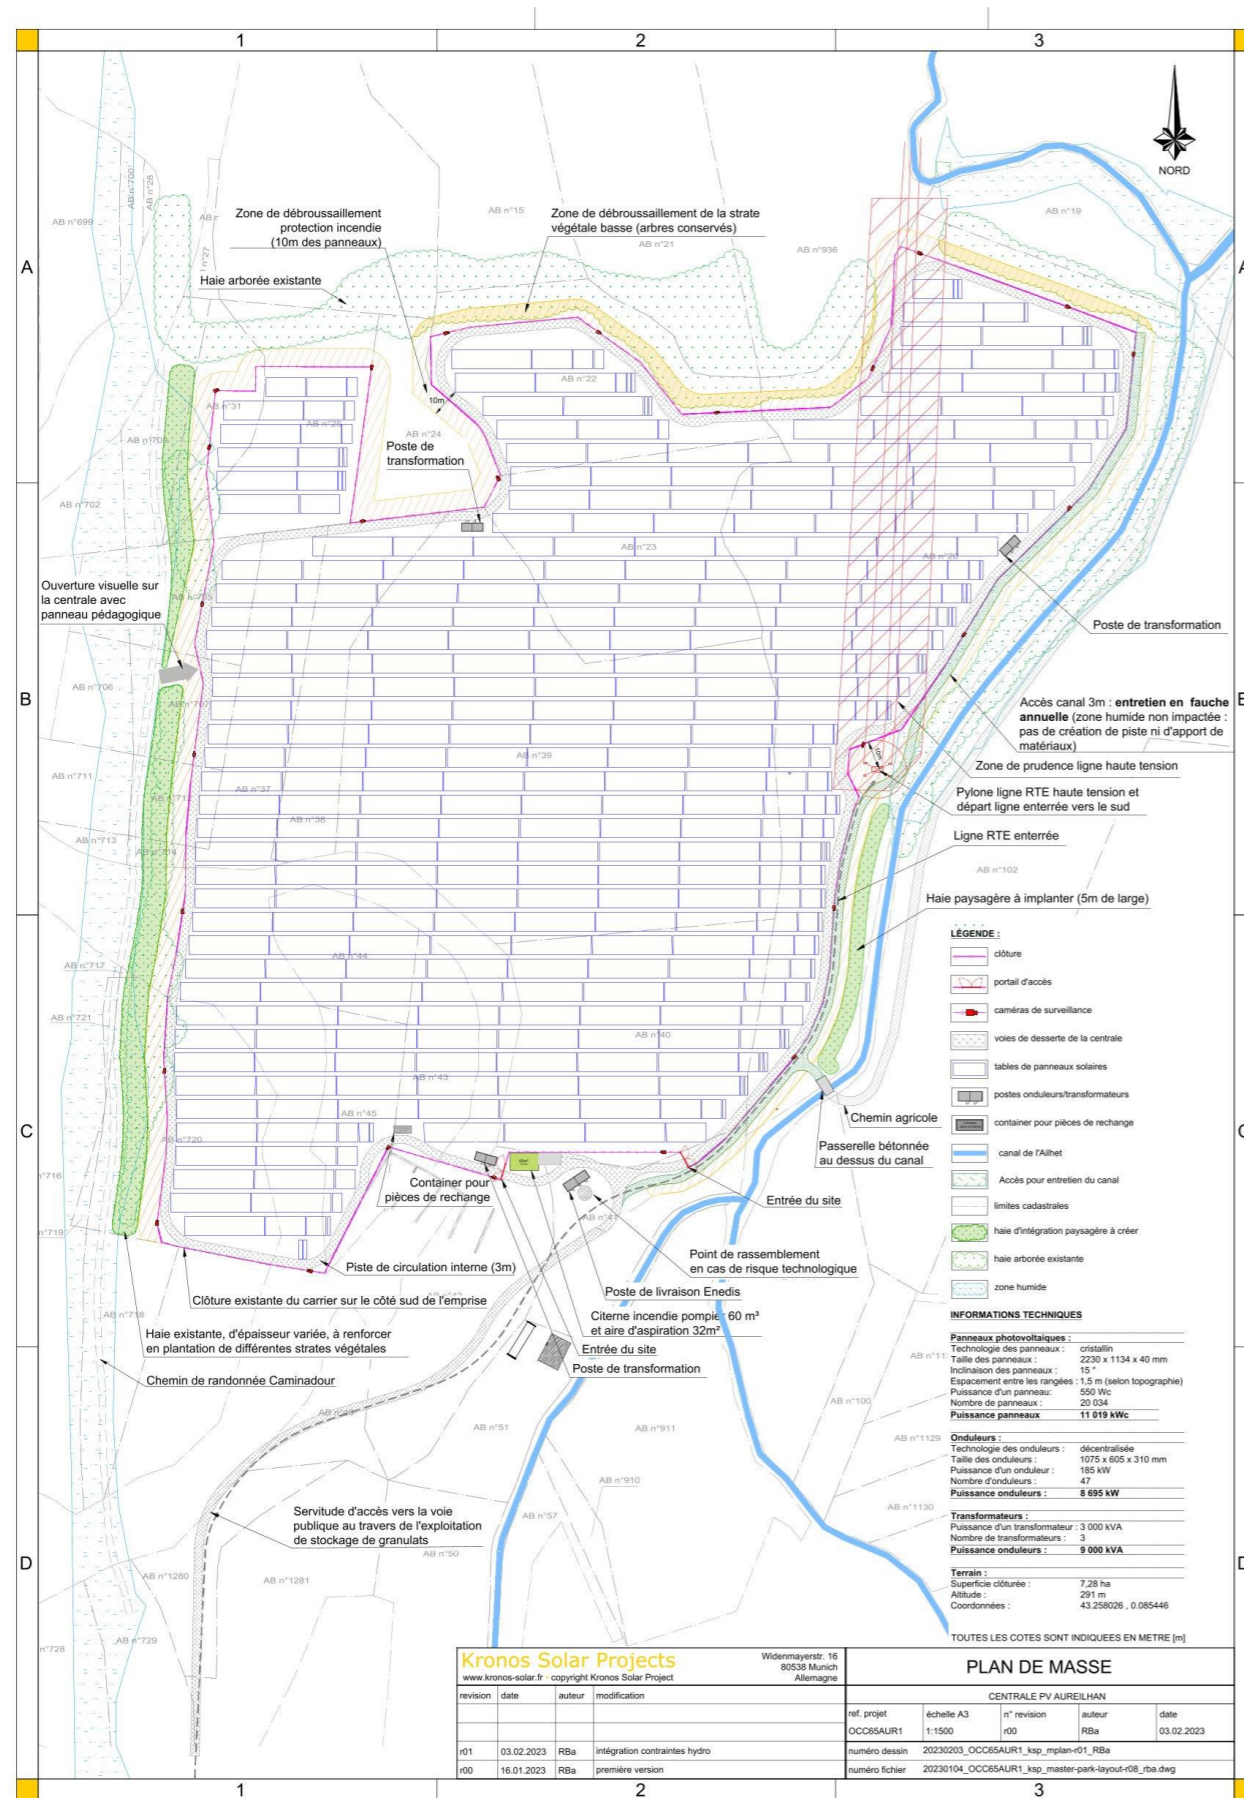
Plan de masse - version finale (Source : Porteur de projet)
